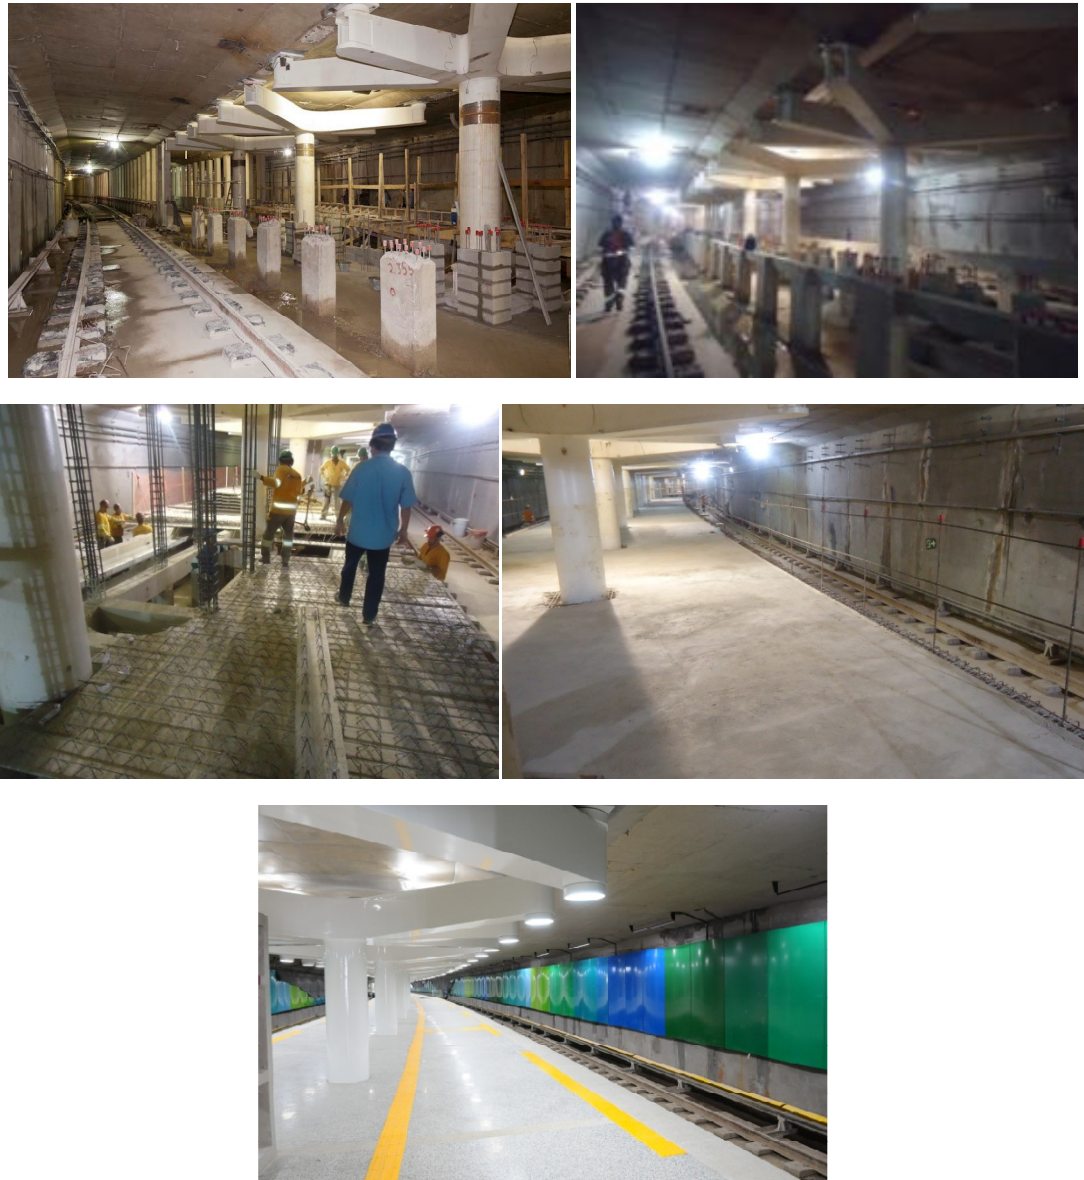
Fotos da construção da plataforma usando lajes treliçadas.
